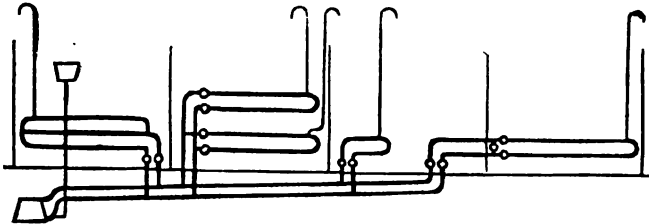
Section longitudinale montrant la disposition des conduites maitresses et des tuyaux de chaufferie.
